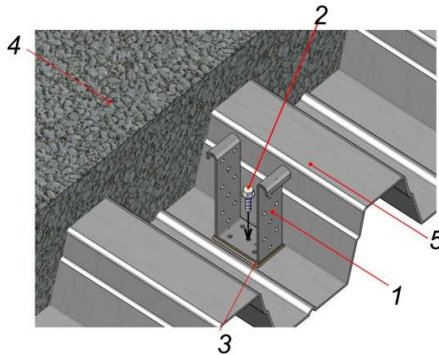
□ Анкер у прольоті сталезалізобетонної плити перекриття
